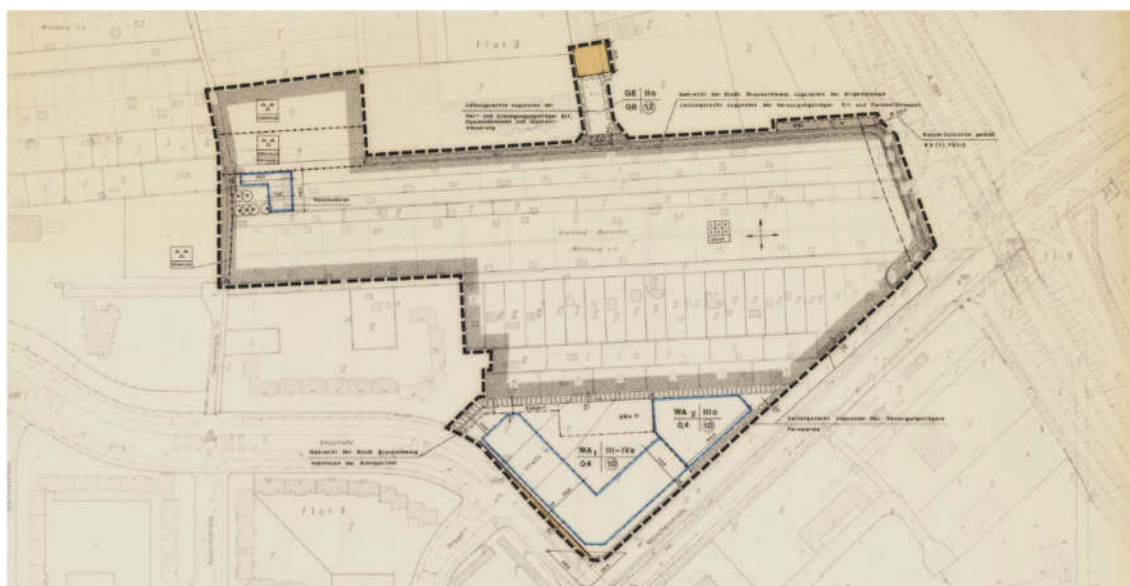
Auszug aus der Planzeichnung des Bauungsplans HO27
